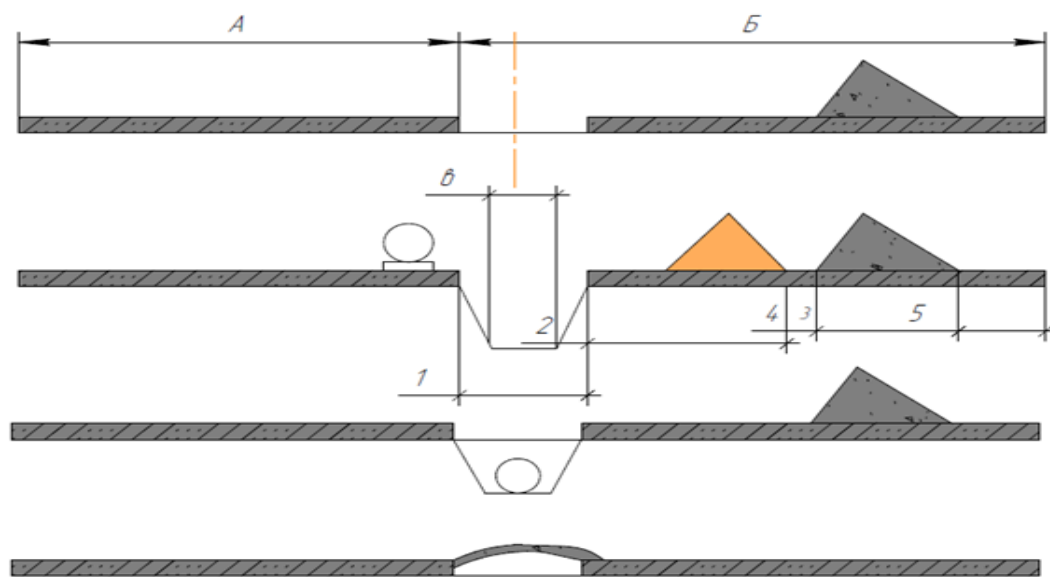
Схема по планировки снятия верхнего слоя грунта
